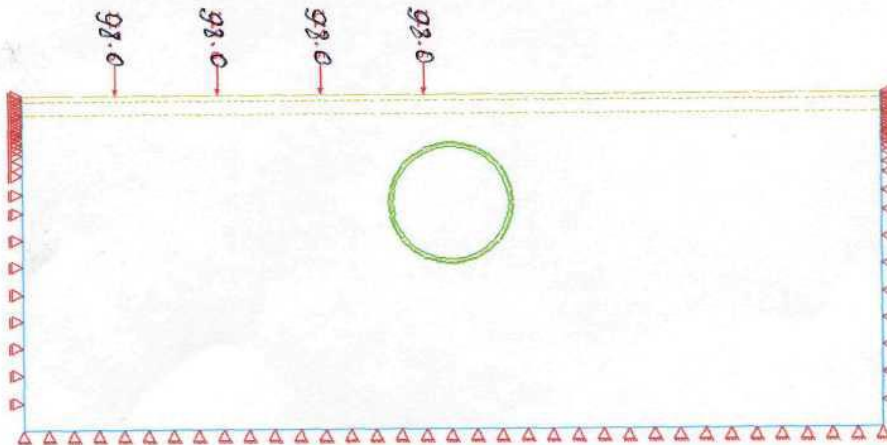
Схема нагрузки (нагрузка находится на призме обрушения)
